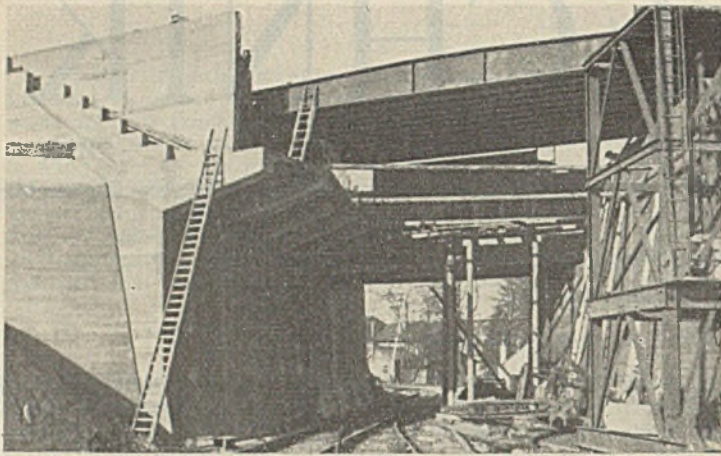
Geschweißte Nasenprofilträger des Bahnüberbaues.
